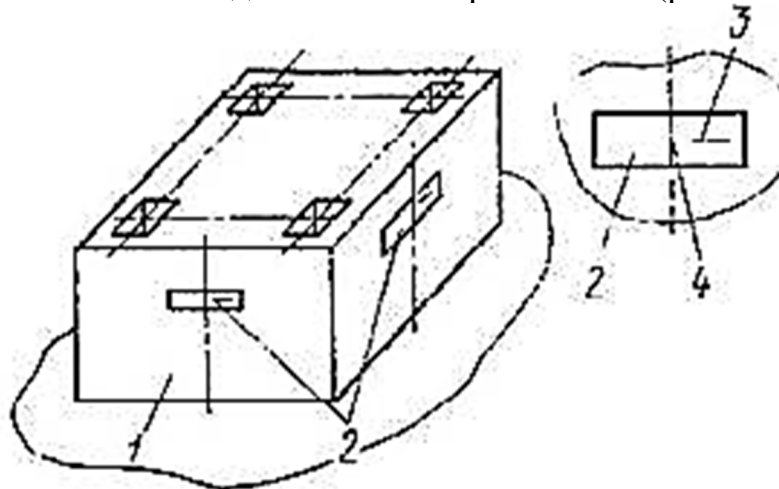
Схема планки для нанесения на фундаментах осей и высотных отметок:
